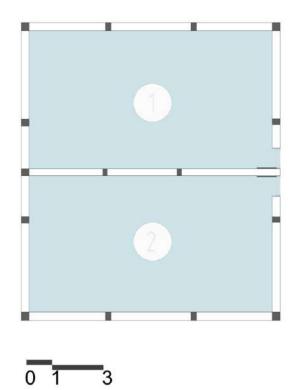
Planta 1 Bloque 42. Fuente: Equipo de diagnóstico.
